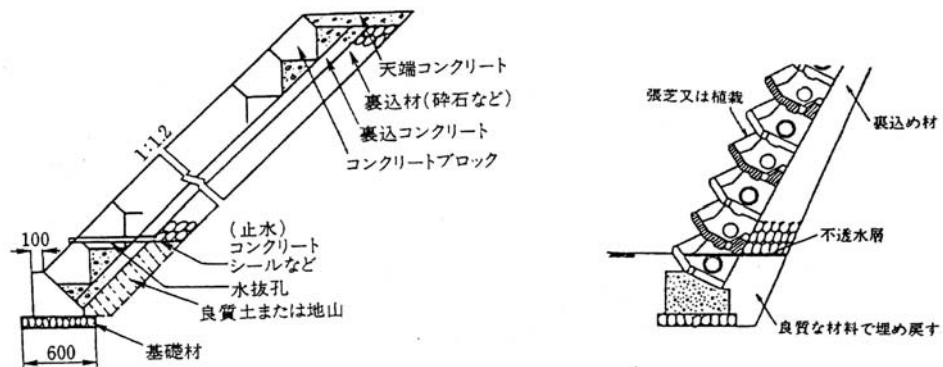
コンクリートブロック張工の例・緑化ブロックの例
